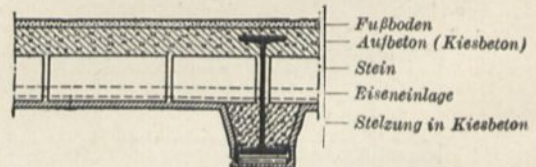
Kleinesche Decke mit Stelzung. (Aus „Eisen im Hochbau“.)
